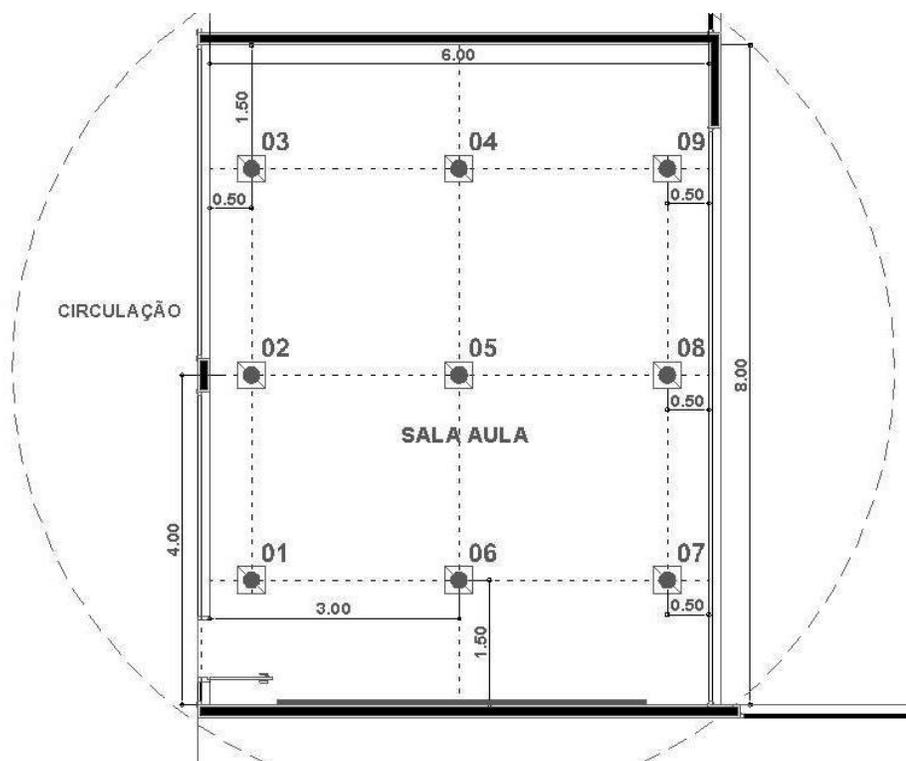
Planta das salas de aula - PONTOS DE MEDIÇÃO.
